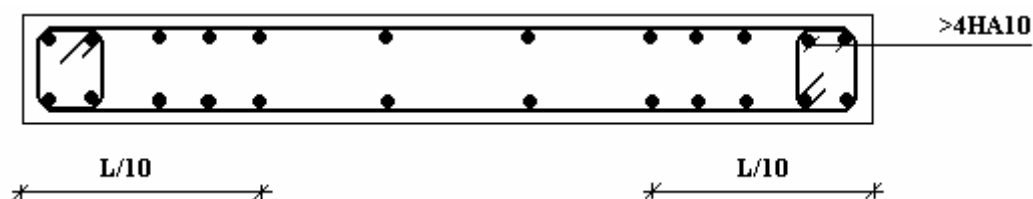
Disposition des armatures verticales dans les voiles.
